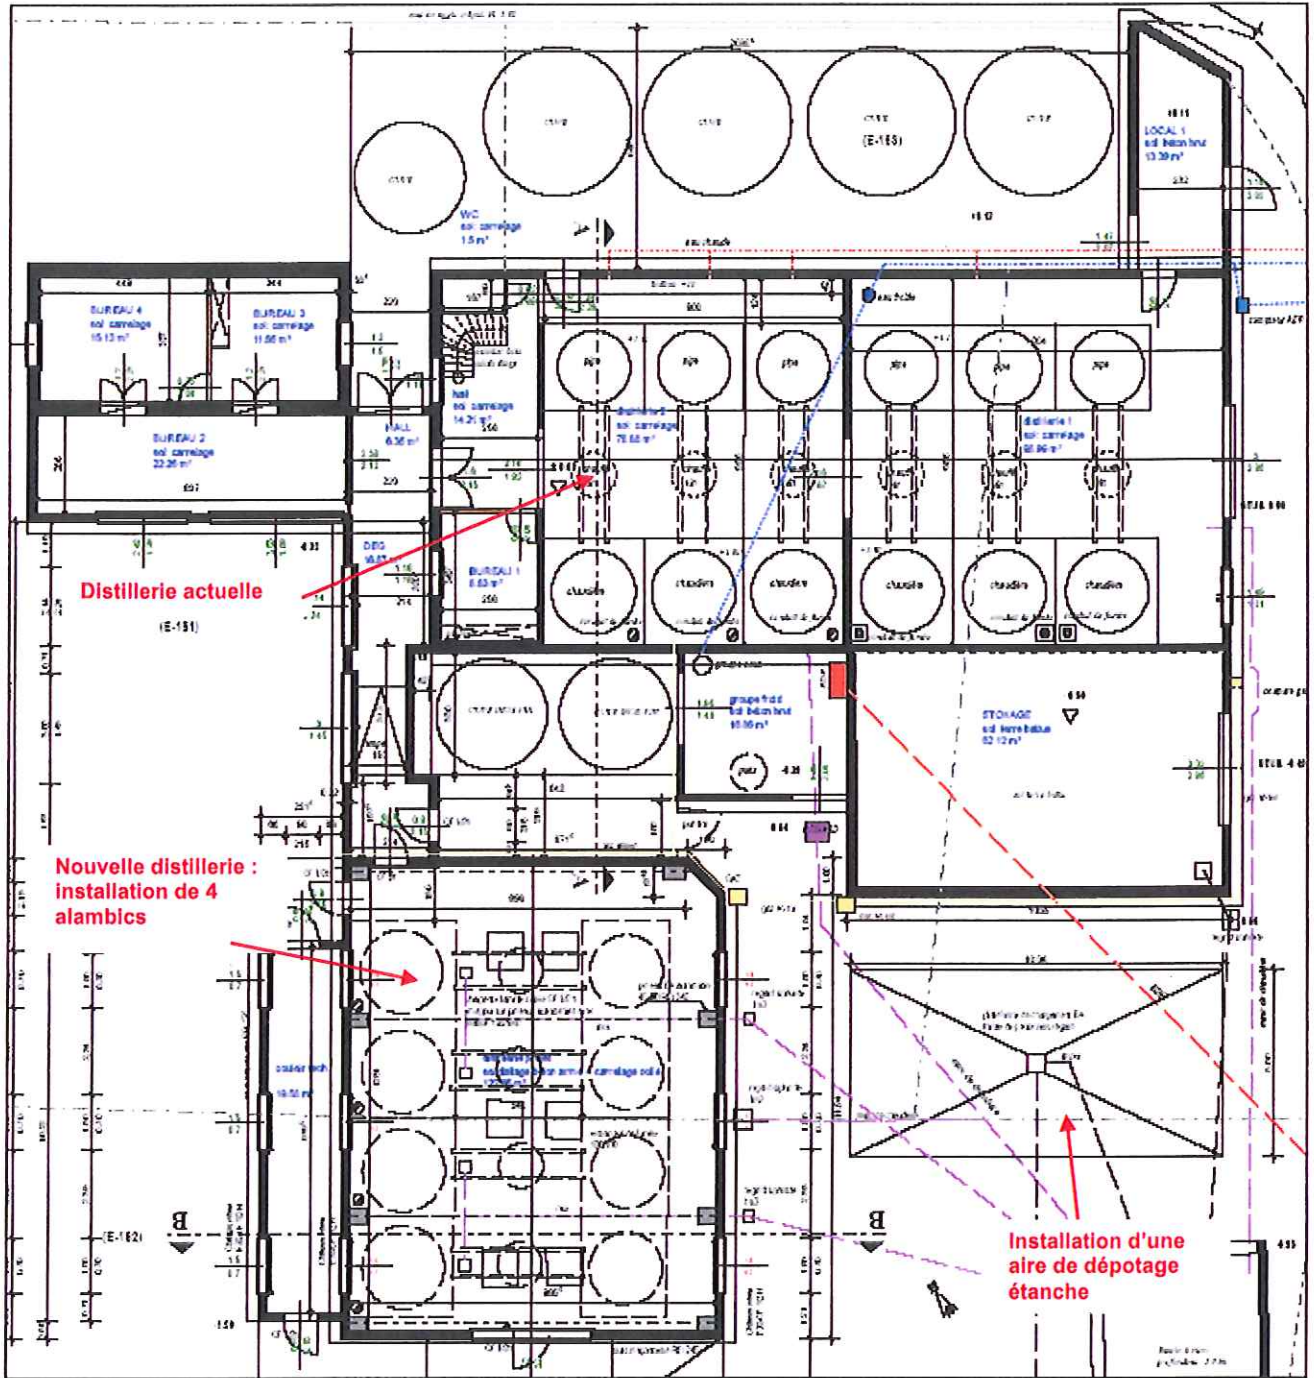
Plan du site avec l'implantation de la nouvelle distillerie
